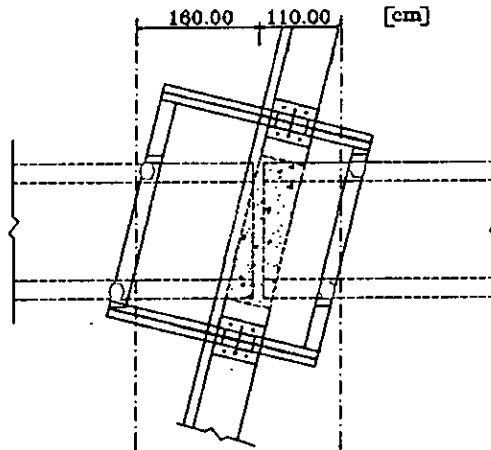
Vista en planta del marco en el Apoyo 7.
